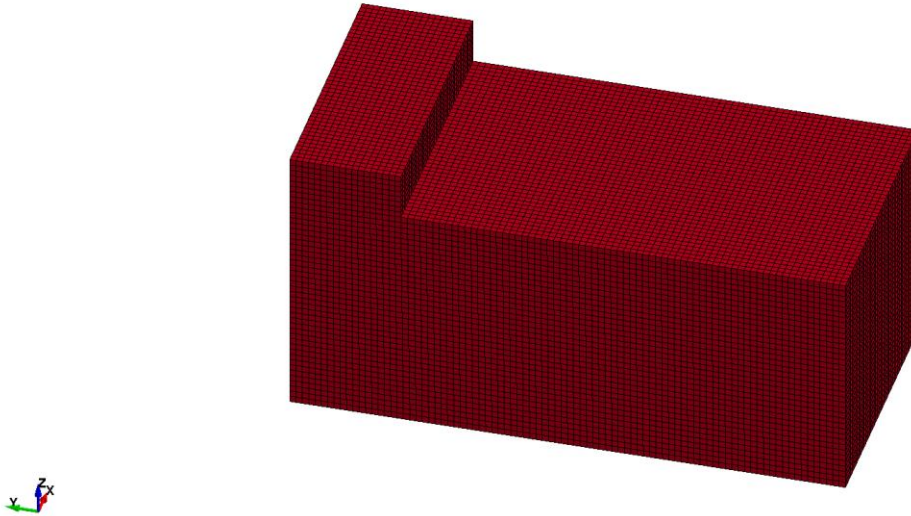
Vista de Hormigón en Modelo Ceba Simple de Puente Águila Norte.
